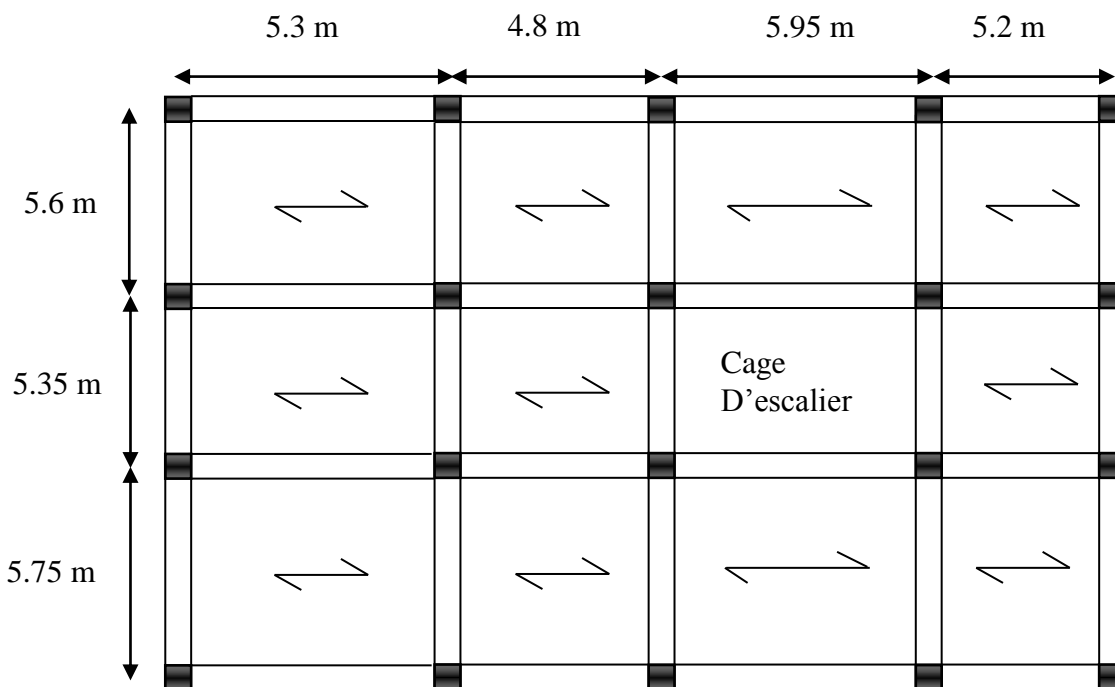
Sens de la disposition des poutrelles de la soupente jusqu'au 4em étage
